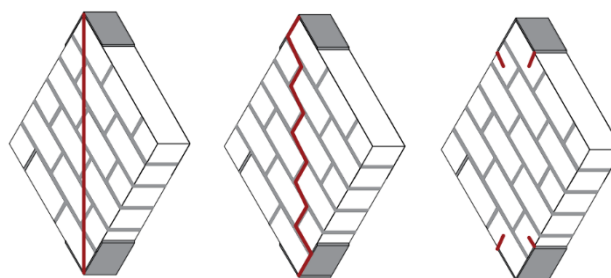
Fallas típicas en un estado de compresión diagonal en muretes de albañilería
